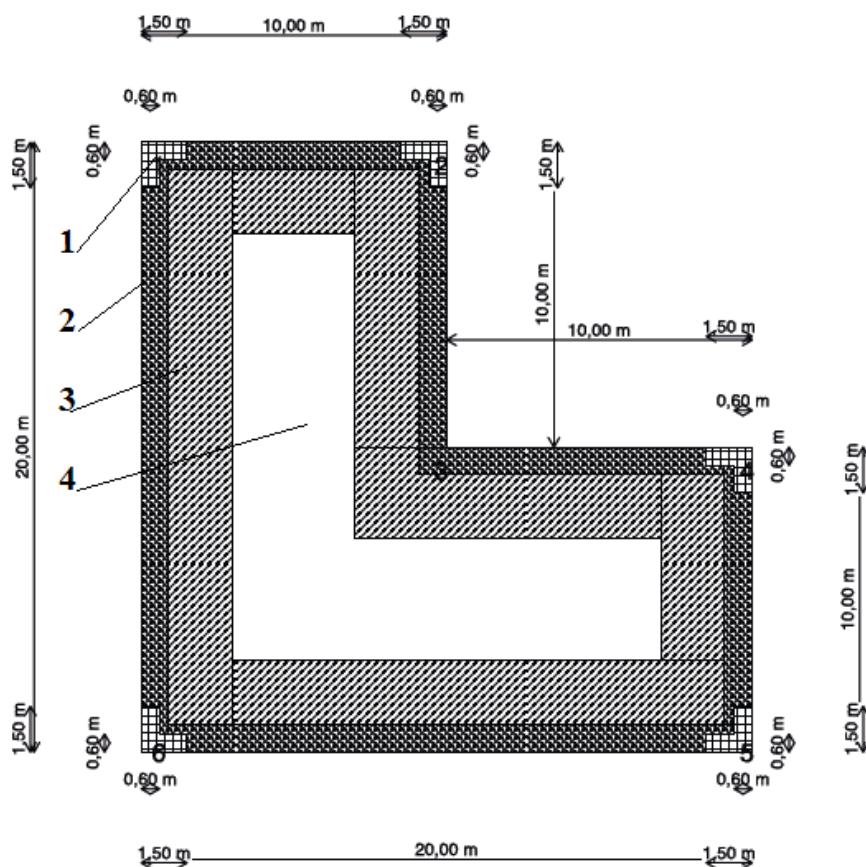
Проектирование закрепления кровельного ковра от ветровой нагрузки с подхватыванием порывами ветра: 1 — в углах; 2 — на наружном крае; 3 — на внутреннем крае; 4 — внутри кровельного покрытия
